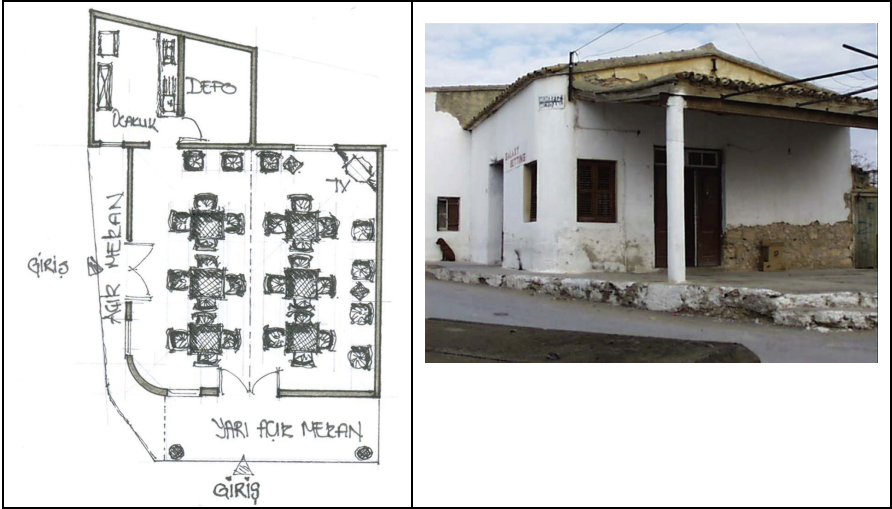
Gönendere Köyü, Hüseyin İlgililer'e ait köy kahvehanesi plan ve fotoğrafı
